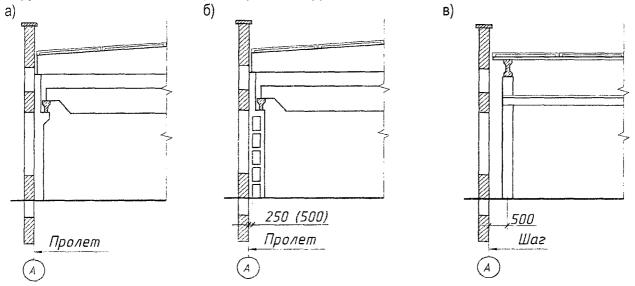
Привязка колонн и наружных стен к разбивочным осям - продольным: а – нулевая, б – 250; 500, в - поперечным.
